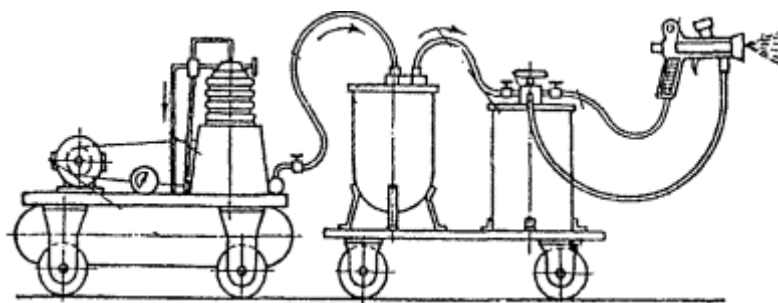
Компресорно-огрунтовочний агрегат
